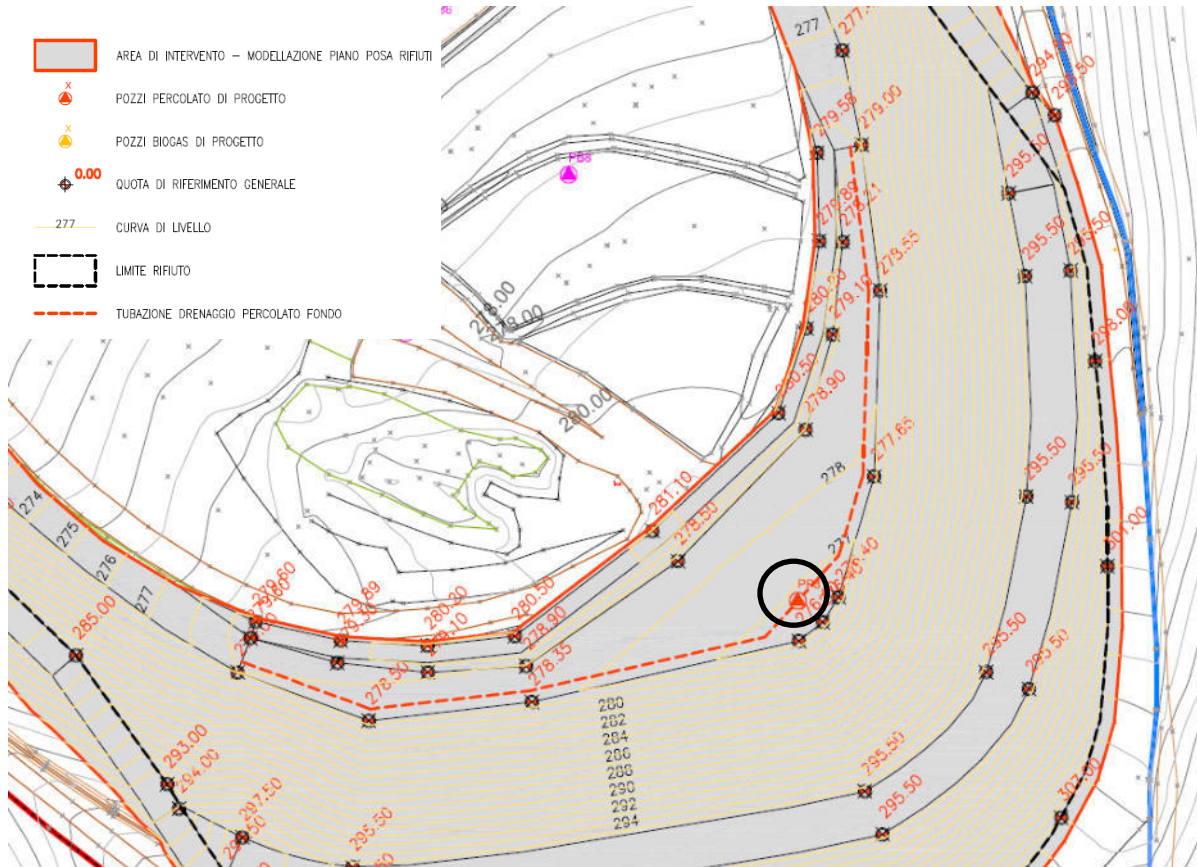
Planimetria con individuazione della linea di drenaggio del percolato sul fondo vasca
